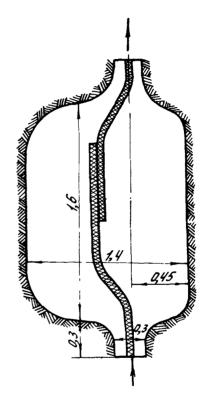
Рис. IO. Котлован дин монтажа муфт с выкладкой кабеля
